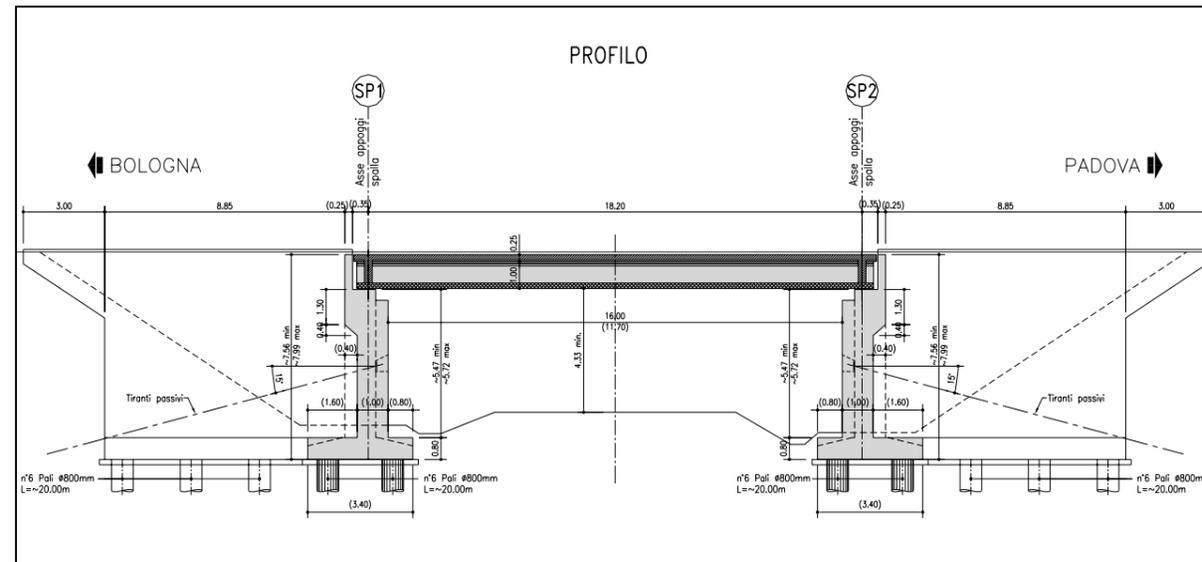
Sezione dell'impalcato e profilo del sottovia della SP 14
